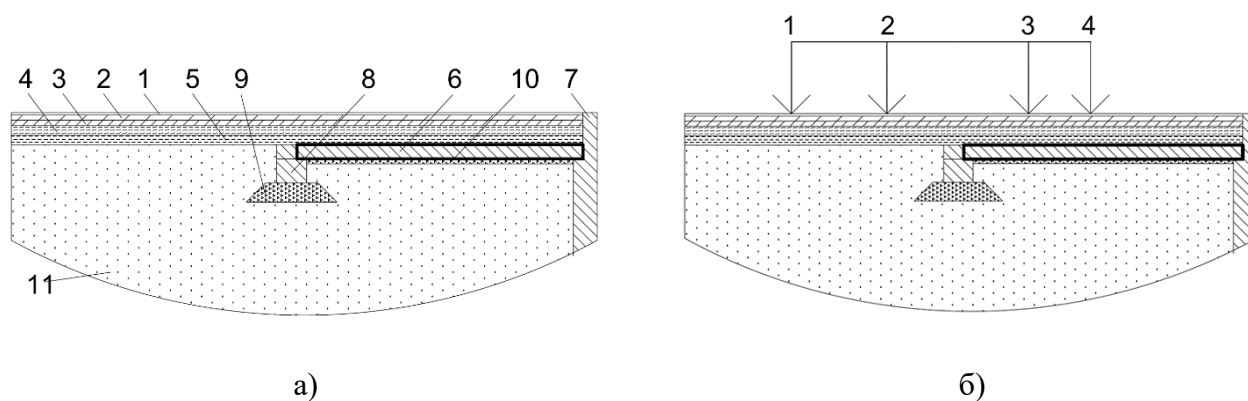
Схема сполучення мостової споруди з насипом підходу: а - перехідна плита влаштована горизонтально на глибину дорожнього одягу; 1-2 - шари асфальтобетонного покриття; 3-5 - шари основи; 6 - перехідна плита; 7 - стоян (берегова опора); 8 - лежень; 9-10 - щебенева подушка; 11 - ґрунт земляного полотна (дренуючий) – пісок; б - навантаження нежорсткого дорожнього одягу від чотирьохвісного автомобіля
